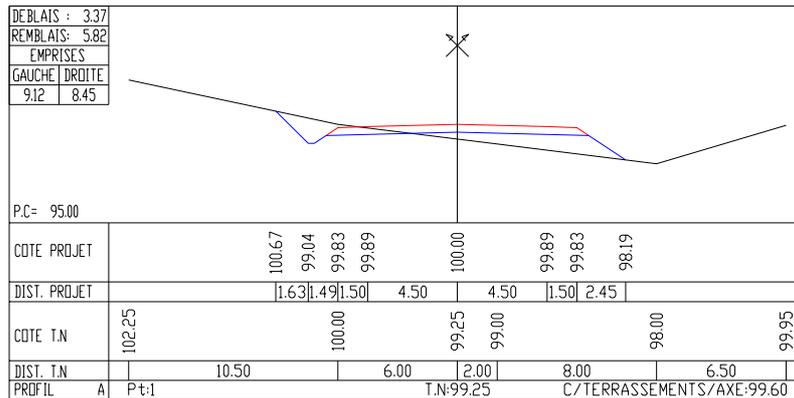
profil en travers en alignement droit avec des devers en toits (chapeau)
